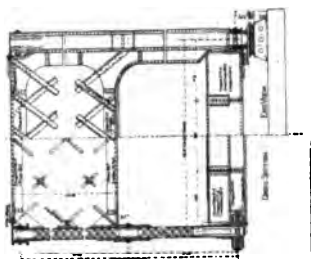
Pont de Cairo. — Travée de 122^m,00.
